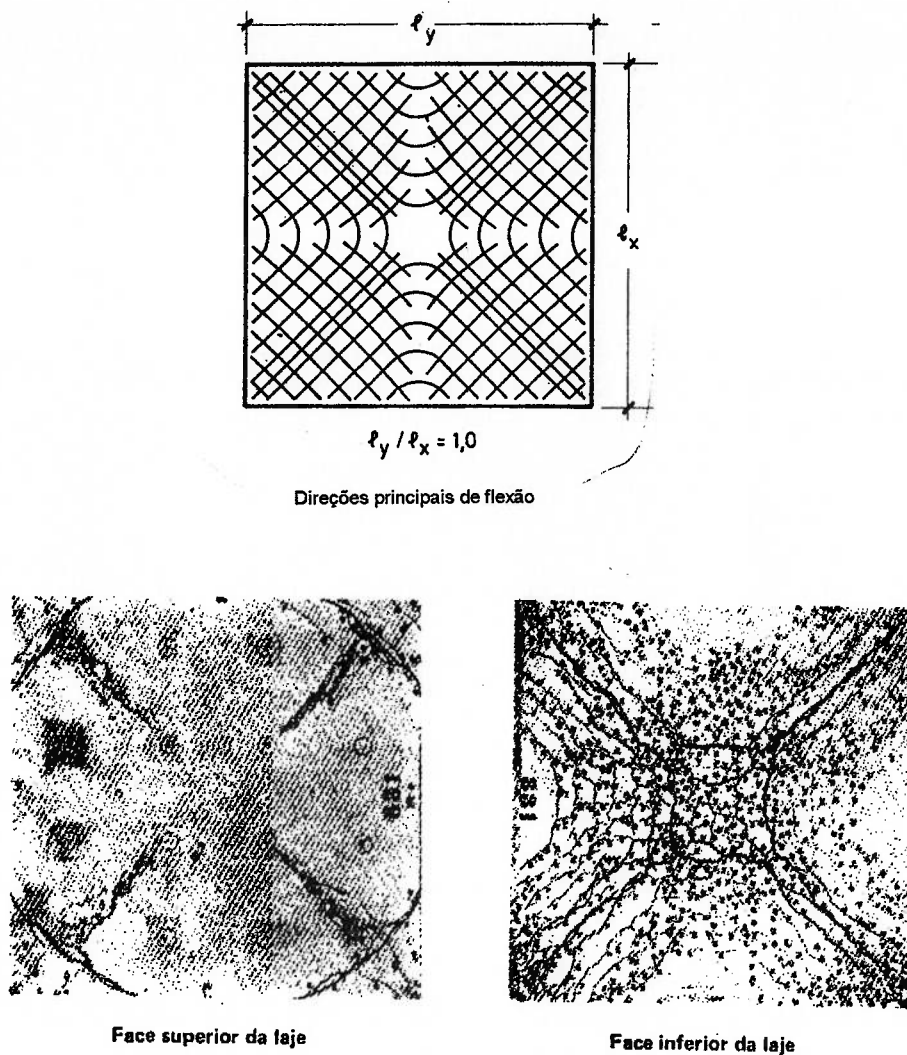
Direções principais de flexão e fissuração da laje quadrada acima referida
